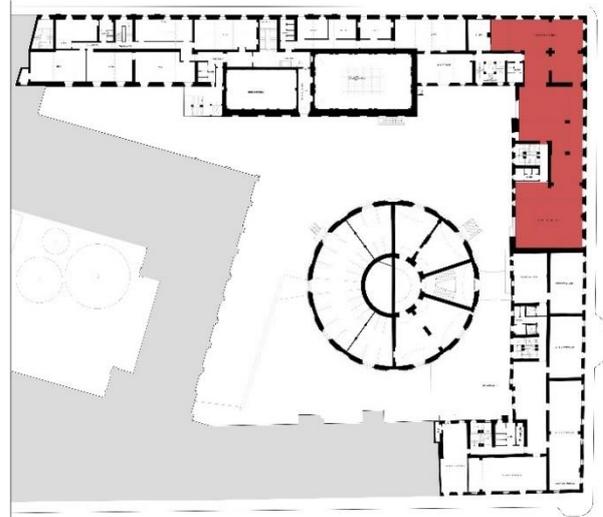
a dx. Masterplan, Pittura, piani 3, 4.
